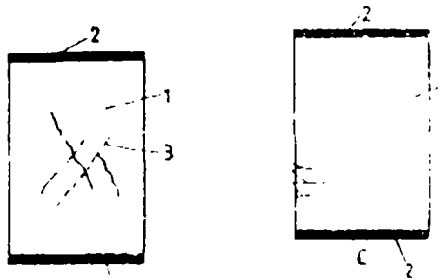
Avarii la pereții plini din beton armat monolit. :
